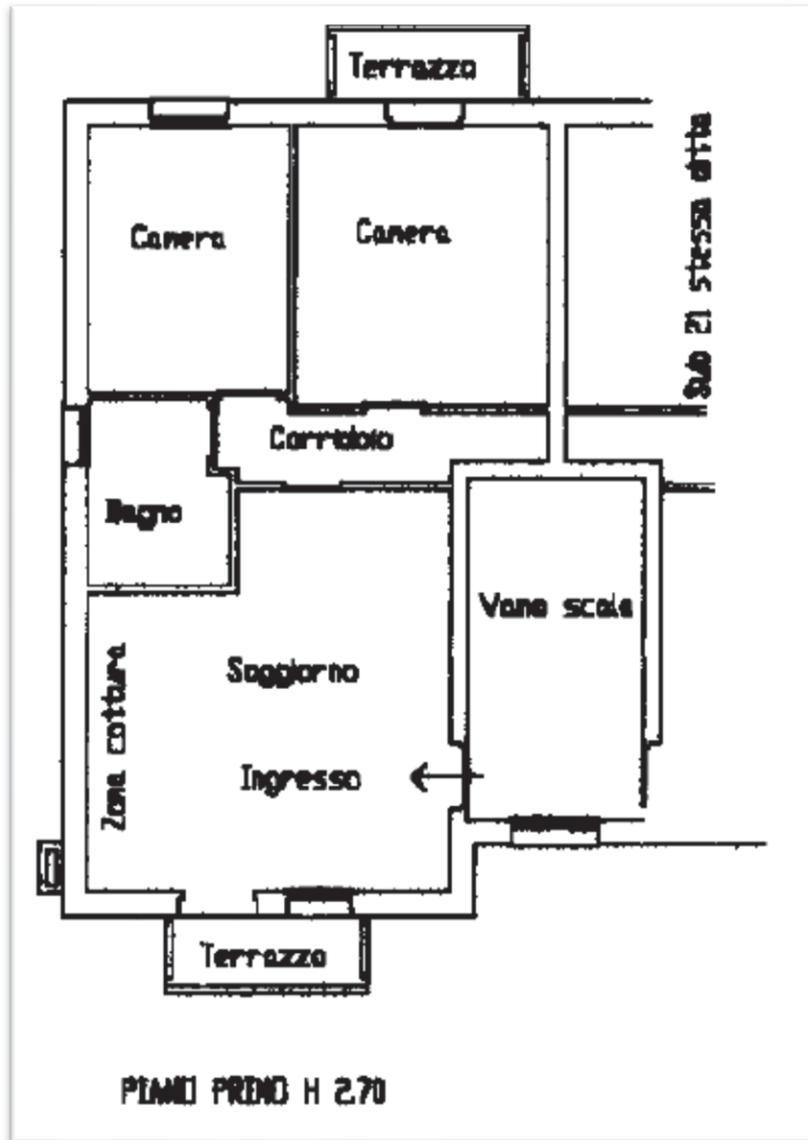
a: Planimetria catastale appartamento sub. 22, piano primo
